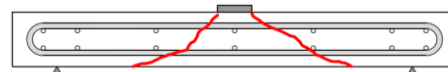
供試体切断面の載荷ひび割れ状況 (供試体 N)
